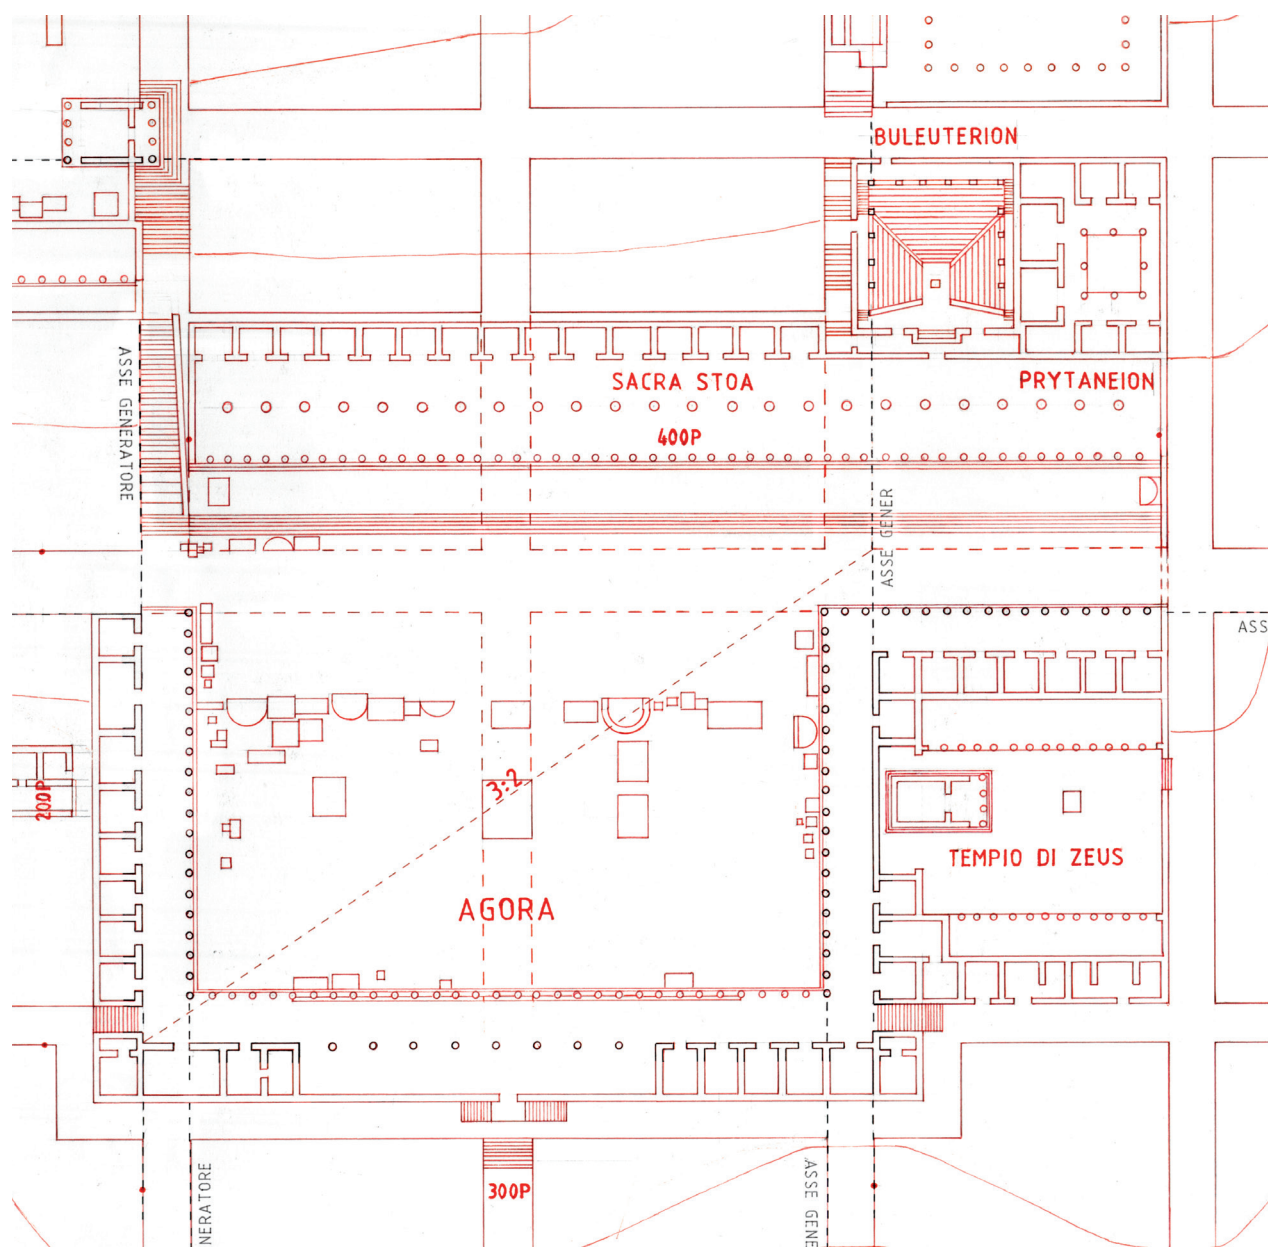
Planimetria dell'agorà e i suoi rapporti armonici. A.R. Burelli.
